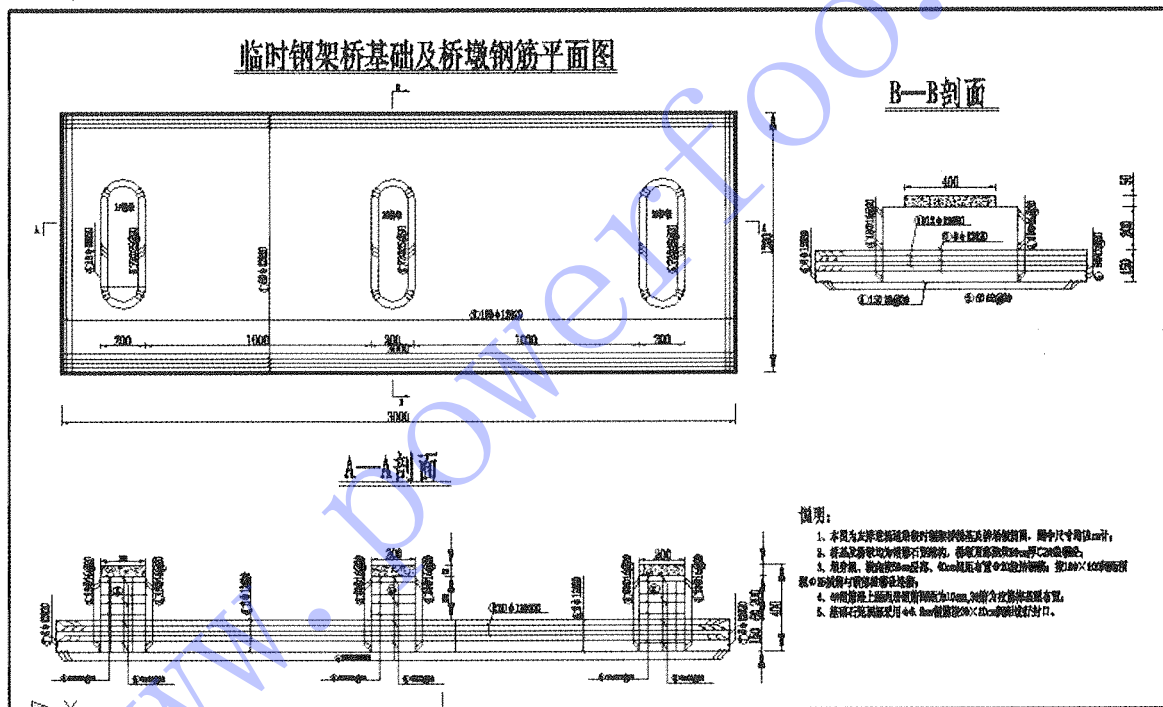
钢架桥基础及桥墩钢筋石笼中的钢筋布置图
